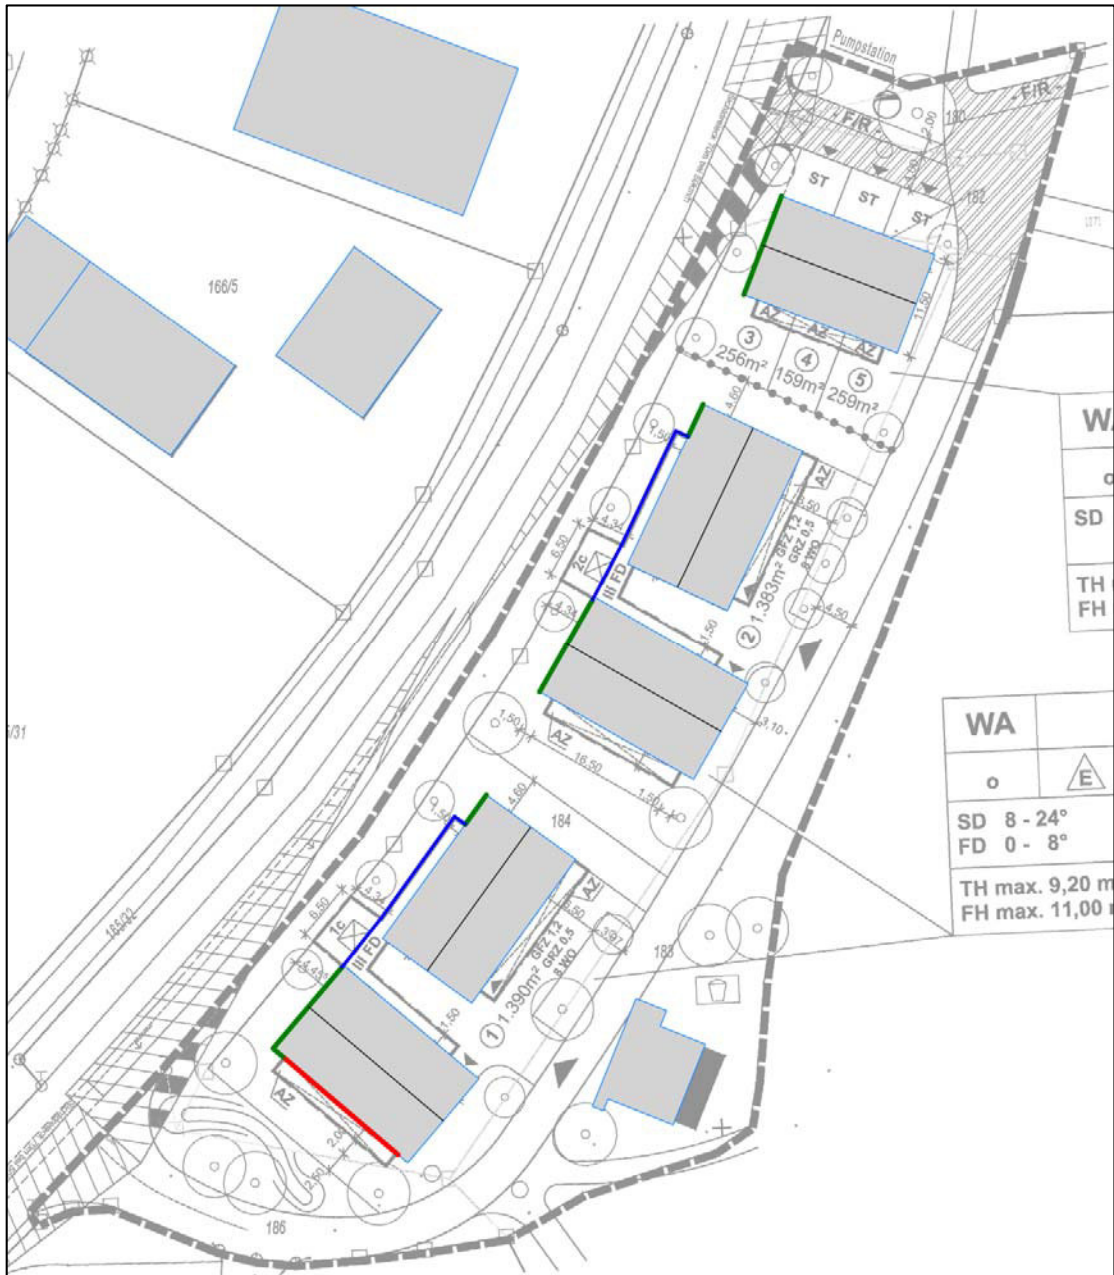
Festsetzungen zu abschirmenden baulichen Maßnahmen und Grundrissorientierung
